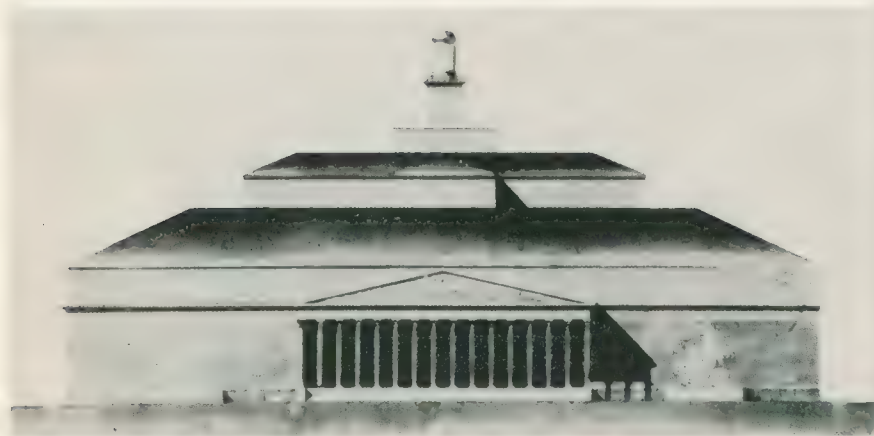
Jappelli. Progetto di Università a Padova. Prospetto. (1824-1825).
